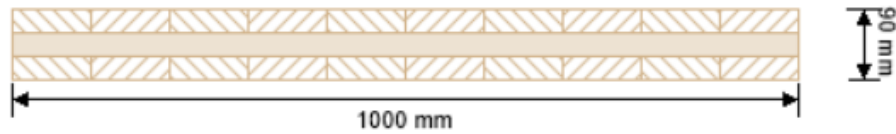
Sección resultante del predimensionamiento de los muros perimetrales con carga distribuida.
